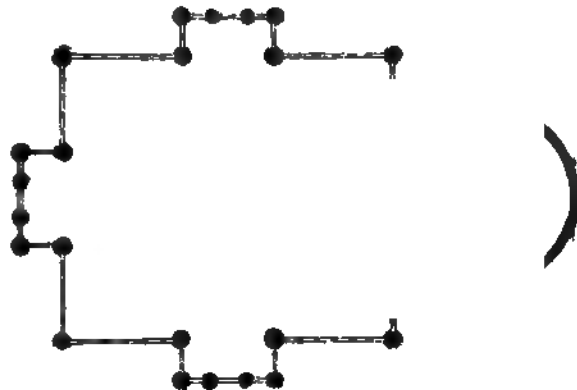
Grundriss der Kirche zu Borgund
